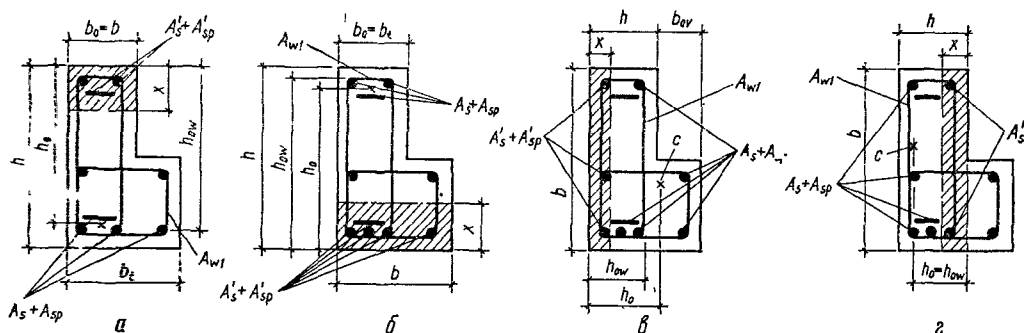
Схема расположения сжатой зоны в пространственном сечении железобетонного элемента Г-образного сечения, работающего на кручение с изгибом:
